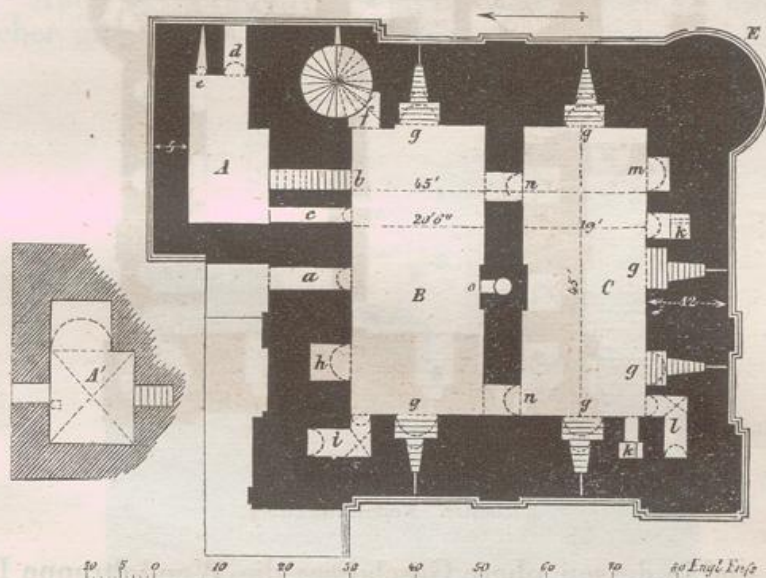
zeigt uns den Grundriss des Erdgeschosses. A' gewölbte Zelle unter dem Erdgeschoße des Vorbaues; die Stufen führen in das Erdgeschoss, nach dem Gemach B; die gegenüber stehende Oeffnung ist neu. A Gemach über dieser Zelle, mit einem Schlitz e, und einer später zur Pforte erweiterten Fensteröffnung d. B grosses Gemach mit zwei Stufenscharten g (die Scharten sind aussen nur 6" breit, ihr Profil erklärt sich aus Fig. 101); zwei Schlafstellen h und i in der Mauerdicke; mit einer unter die Zugbrücke führenden Poterne a, und mit zwei Thüren n n, in das südliche Gemach C. Dieses hat vier Stufenscharten g, und vier Schlafstellen k, k, l, m. In der Mitte der Zwischenmauer befindet sich der bis zur Plattform hinauf reichende Brunnenschacht, der in jedem Stockwerke mit einer Pforte versehen, in seinem Innern
